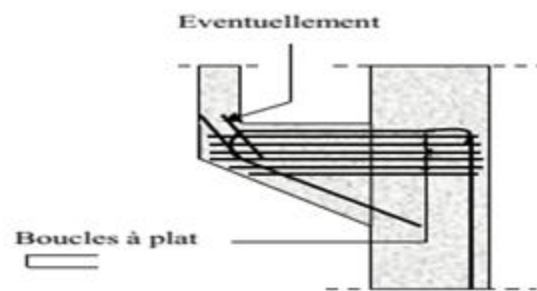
Disposition de ferrailage pour éviter la dégradation du corbeau.
